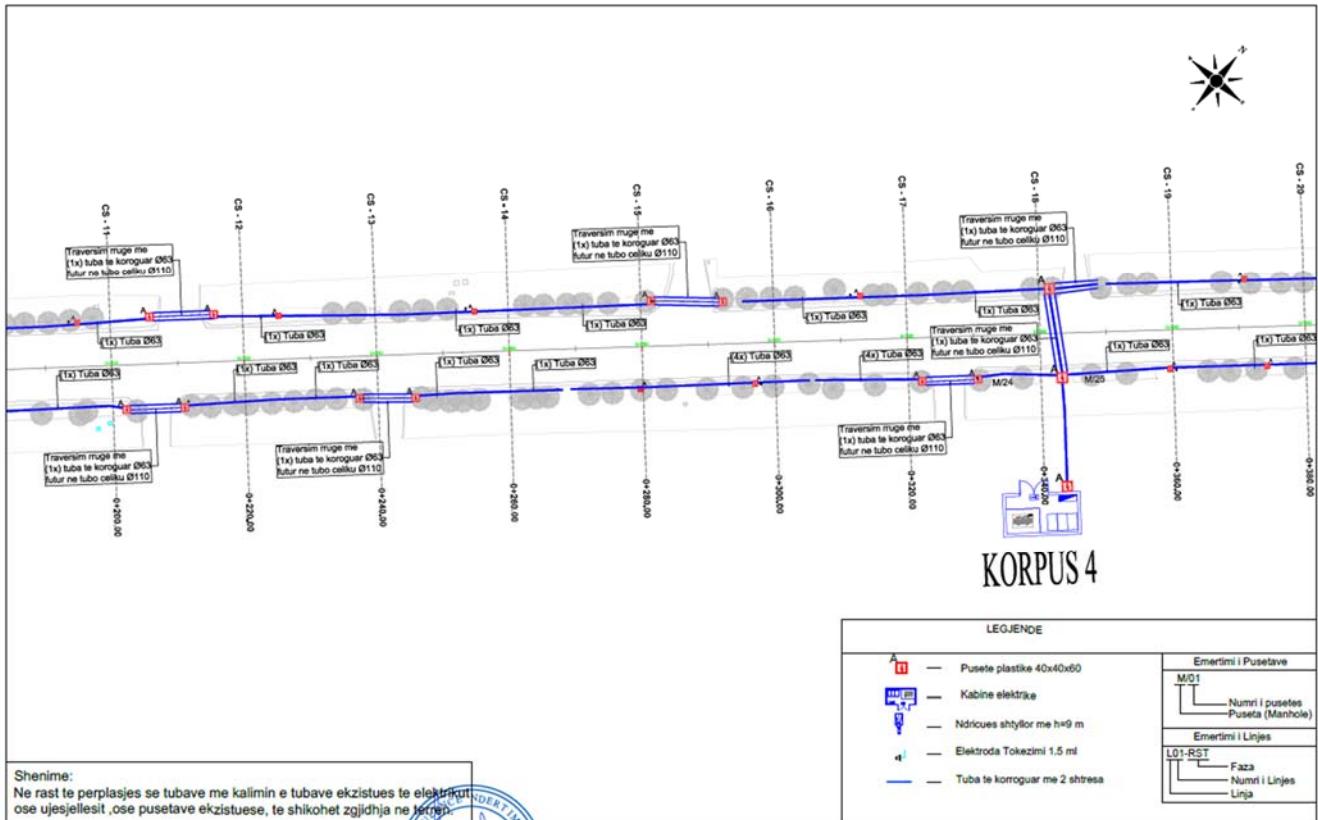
Planimetria e linjave te ndricimit Ruga “Kolë Heqimi”
